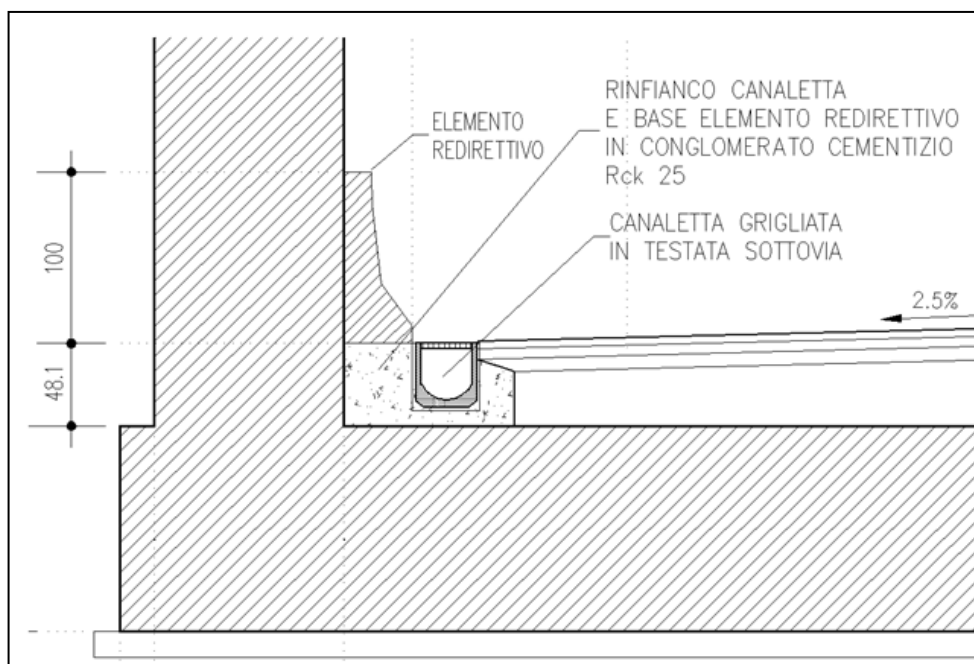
PARTICOLARE POSIZIONAMENTO CANALETTA INTERNA AL SOTTOVIA
